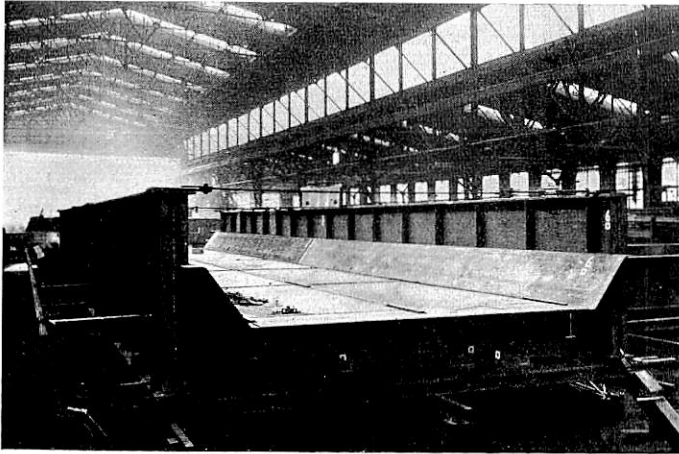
Geschweißte Werkbahnbrücke 1931.
